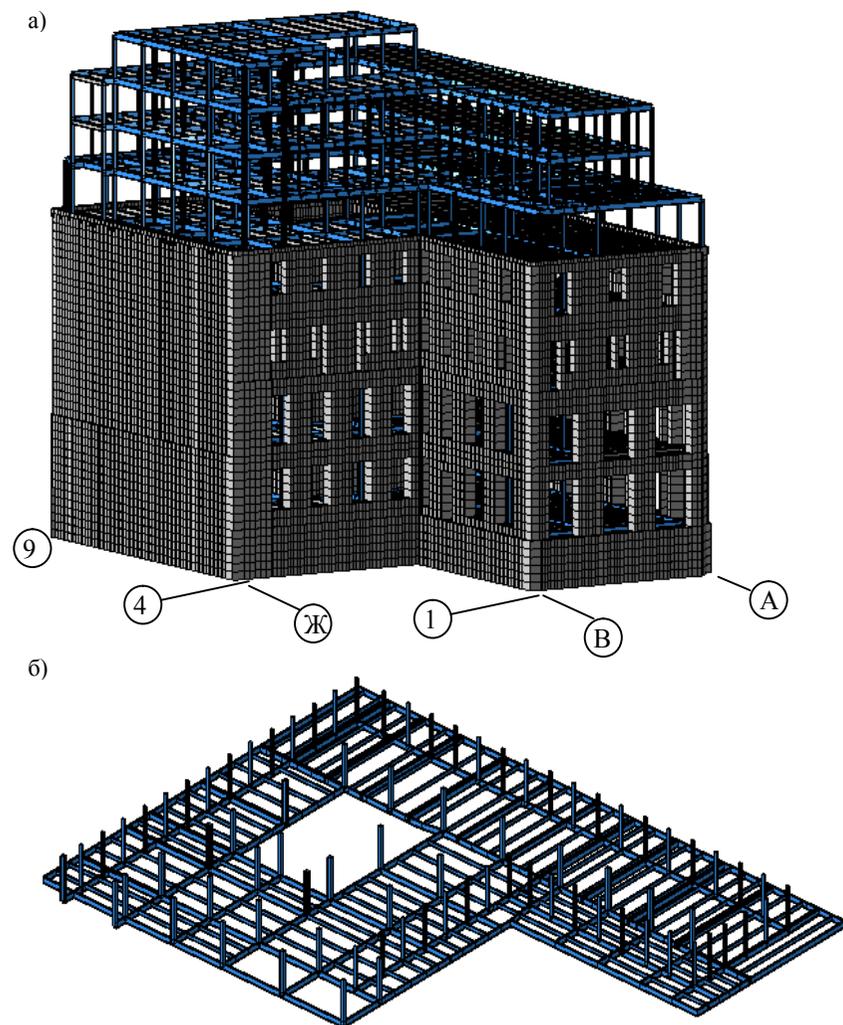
Общий вид компьютерной модели здания (а) и фрагмент мансардного этажа (б)
